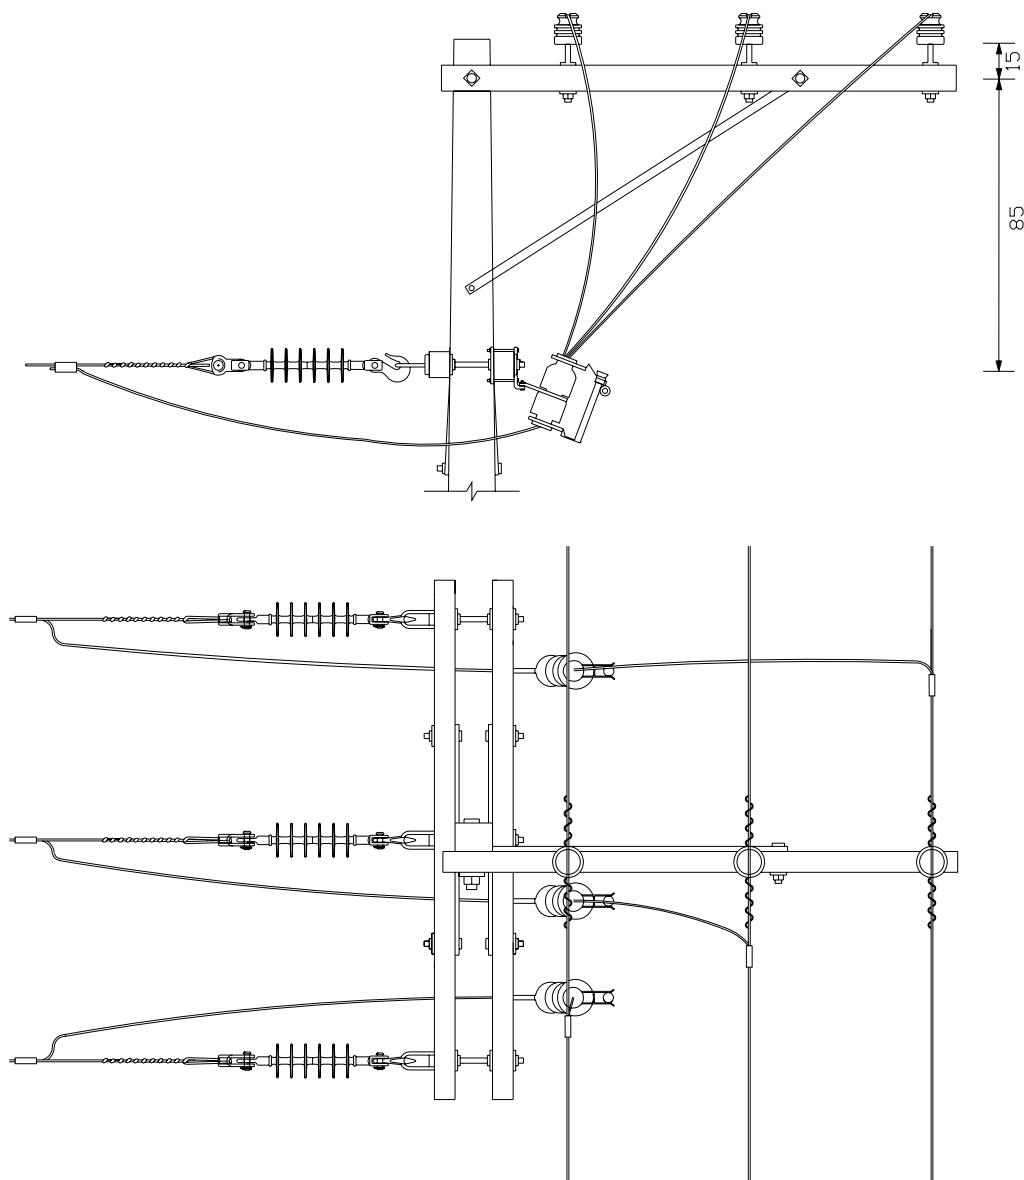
Estrutura B1-N3 (derivação chave fusível)
